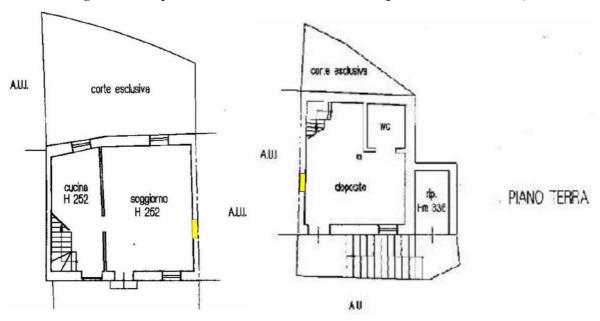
Comparazione stato attuale – stato rilevato (planimetrie non in scala)
